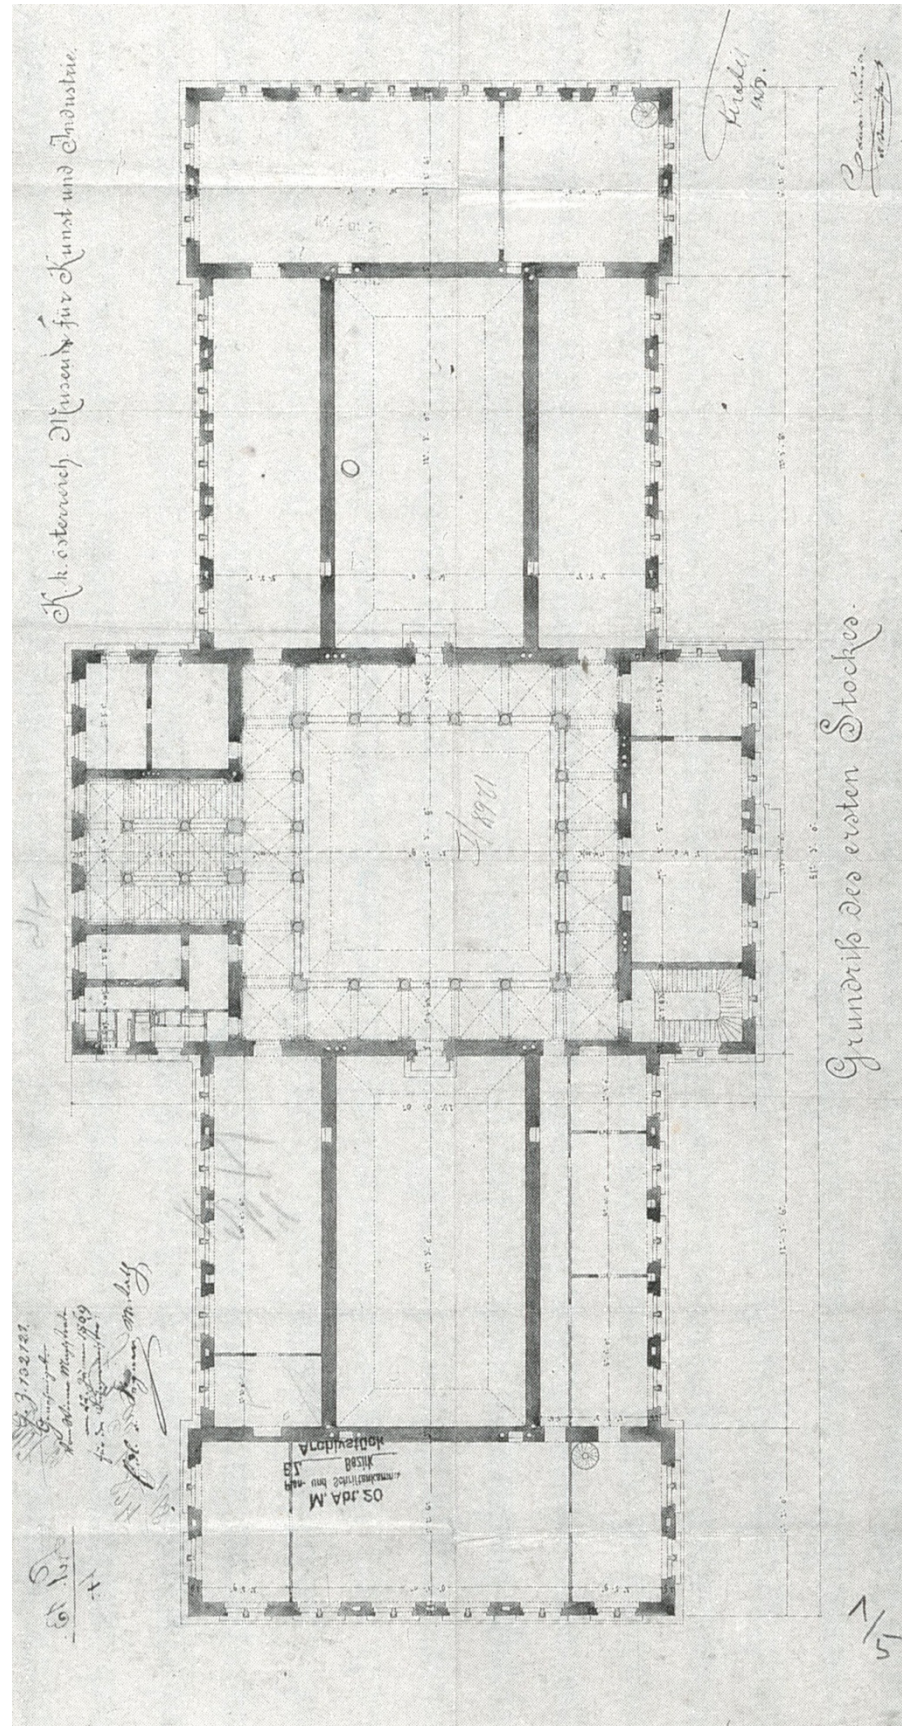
Heinrich von Ferstel, bewilligter Einreichplan, 1. Obergeschoss 1868
